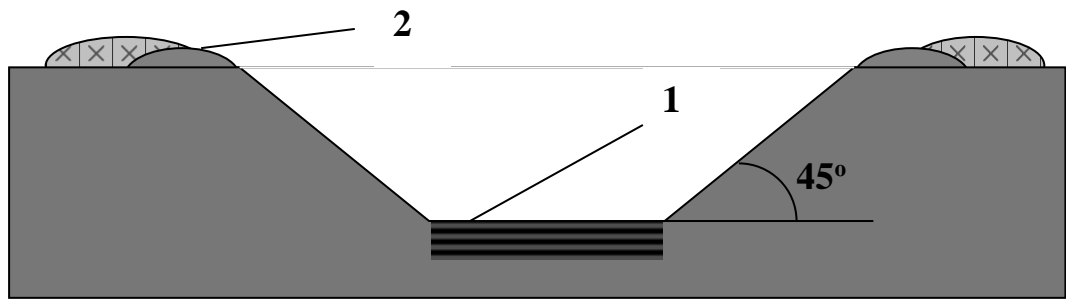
Розробка котловини під фундамент в глинистому ґрунті
